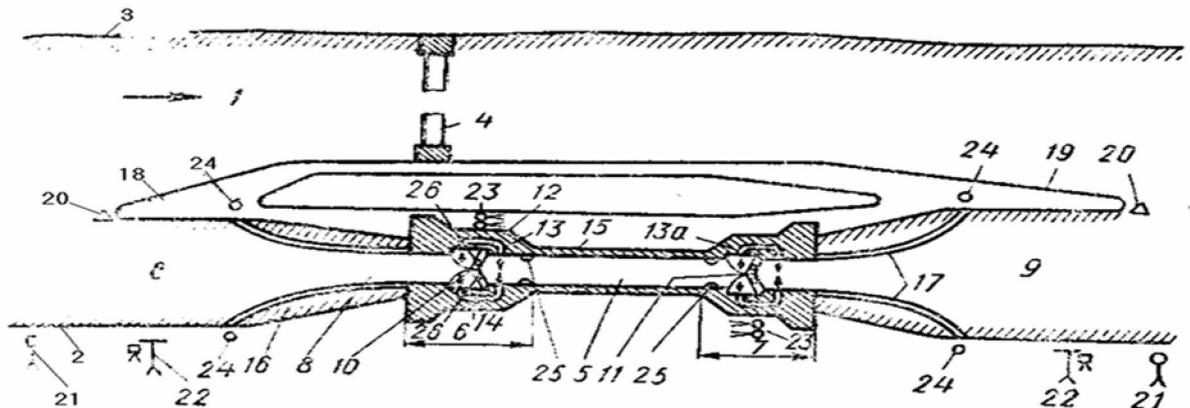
Общая схема шлюза и подхода к нему: 1 — река; 2 — правый берег; 3 — левый берег; 4 — плотина; 5 — камера шлюза; 6 — верхняя голова шлюза; 7 — нижняя голова шлюза; 8 — верхний подходный канал; 9 — нижний подходный канал; 10 — верхние ворота; 11 — нижние ворота; 12 — шкафная ниша для помещения створок открытых ворот; 13 — короткая водопроводная галерея для наполнения камеры шлюза; 13a — водопроводная галерея для опорожнения камеры шлюза; 14 — затвор водопроводной галереи; 15 — стенки камеры шлюза; 16 — верхние направляющие палы-эстакады; 17 — нижние направляющие палы-эстакады; 18 — верхнее разделительное сооружение; 19 — нижнее разделительное сооружение; 20 — белый бакен; 21 — знак «Сигнал»; 22 — семафор или светофор дальнего действия; 23 — двухзначные светофоры, разрешающие или запрещающие выход из камеры; 24 — ограничительные огни на подходах к шлюзу; 25 — стоповые огни на стенках камеры шлюза; 26 — огни на створках ворот шлюза
